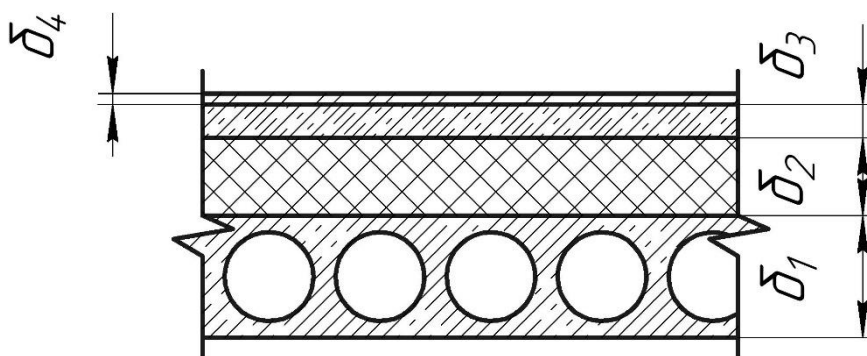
Схема конструкції перекриття над підвалом до теплотехнічного розрахунку
